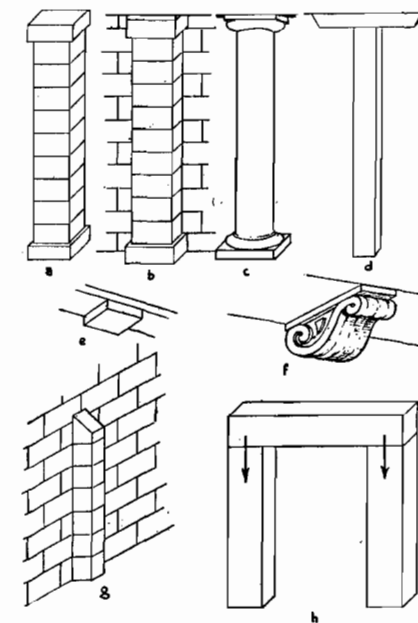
Soportes: a, pilar; b, pilastra; c, columna; d, pie derecho; e, f, ménsulas; g, estribo; h, dintel. (Argilés.)
